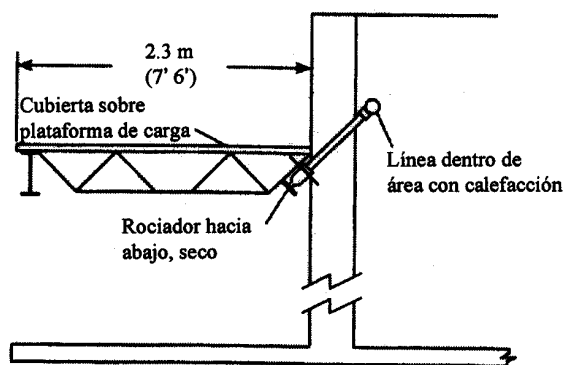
Rociador hacia abajo seco, para la protección de plataformas cubiertas, andenes de carga y áreas similares.
